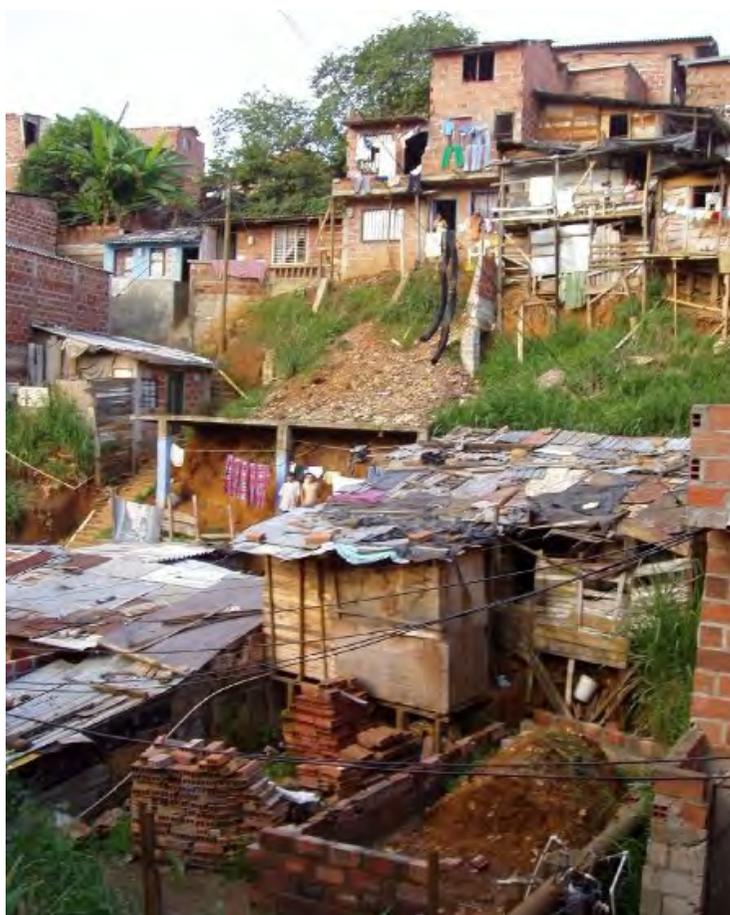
Viviendas emplazadas en la Quebrada de Juan Bobo antes de la intervención, Medellín.
